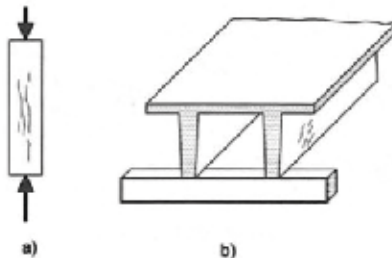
Fisuras por compresión excesiva del hormigón (Fuente: Calavera, 2005)
